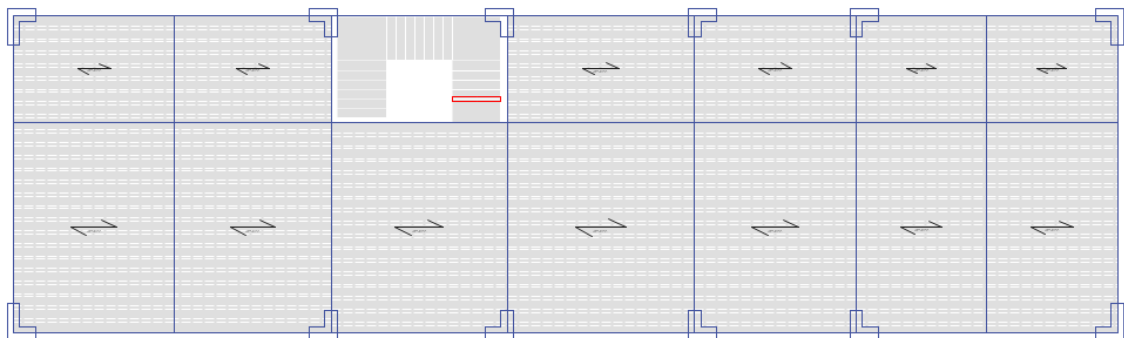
Análisis de la superestructura del Sistema estructural Tradicional – Vista en planta.
